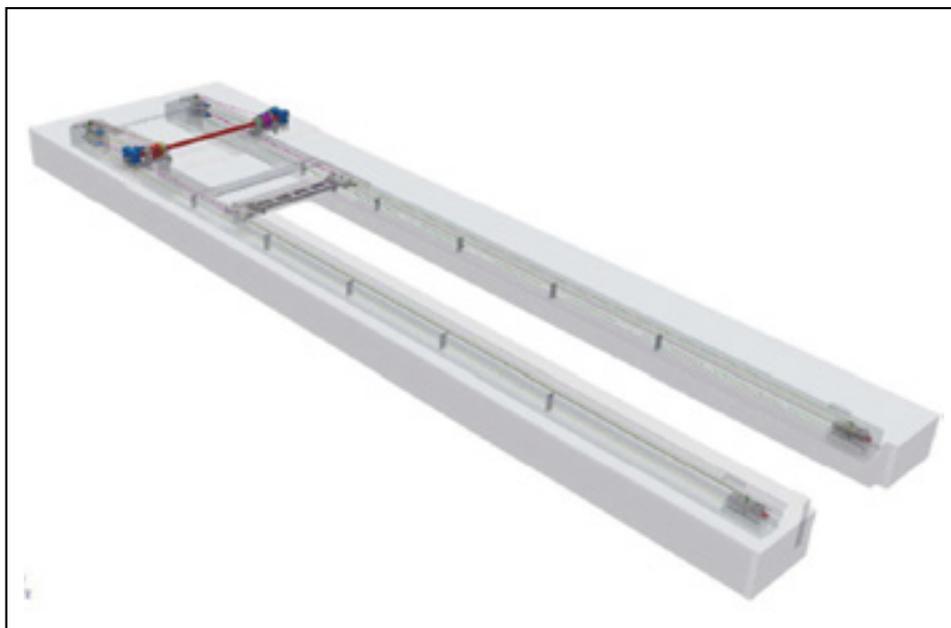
Perspectiva con la maquinaria de tracción y el carril superior de la compuerta.
